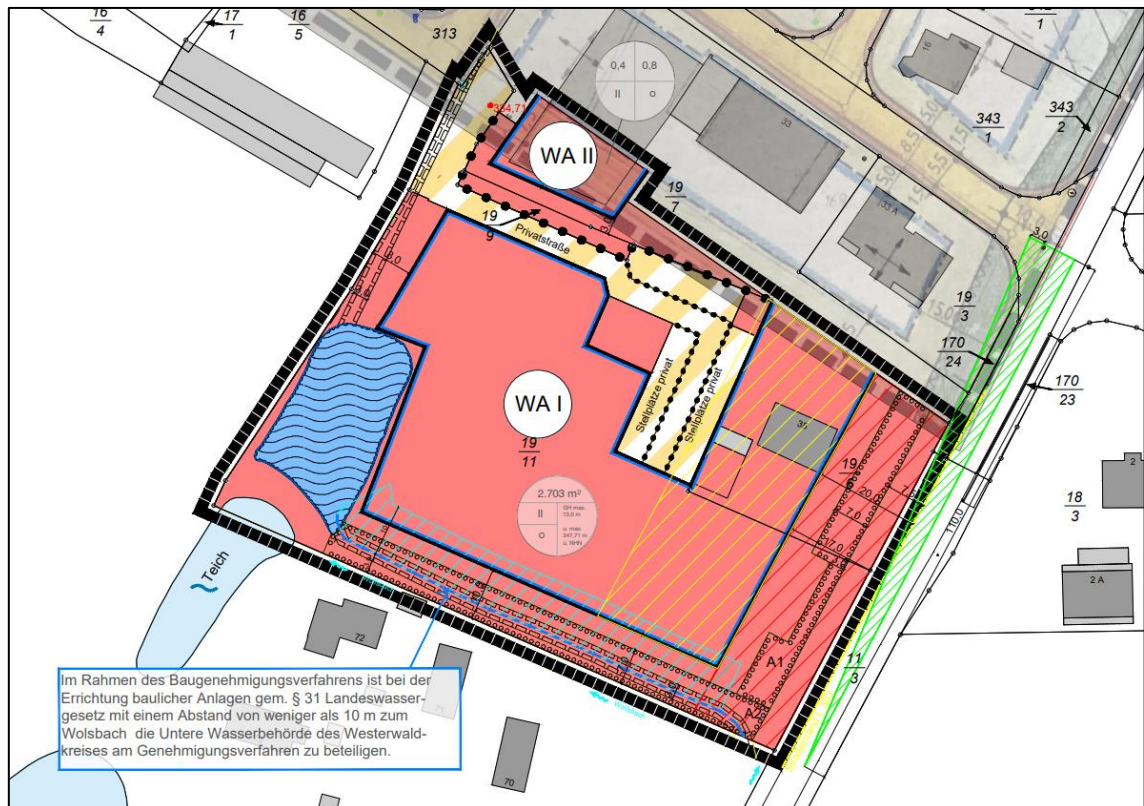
Planzeichnung Entwurf, Stand August 2024
